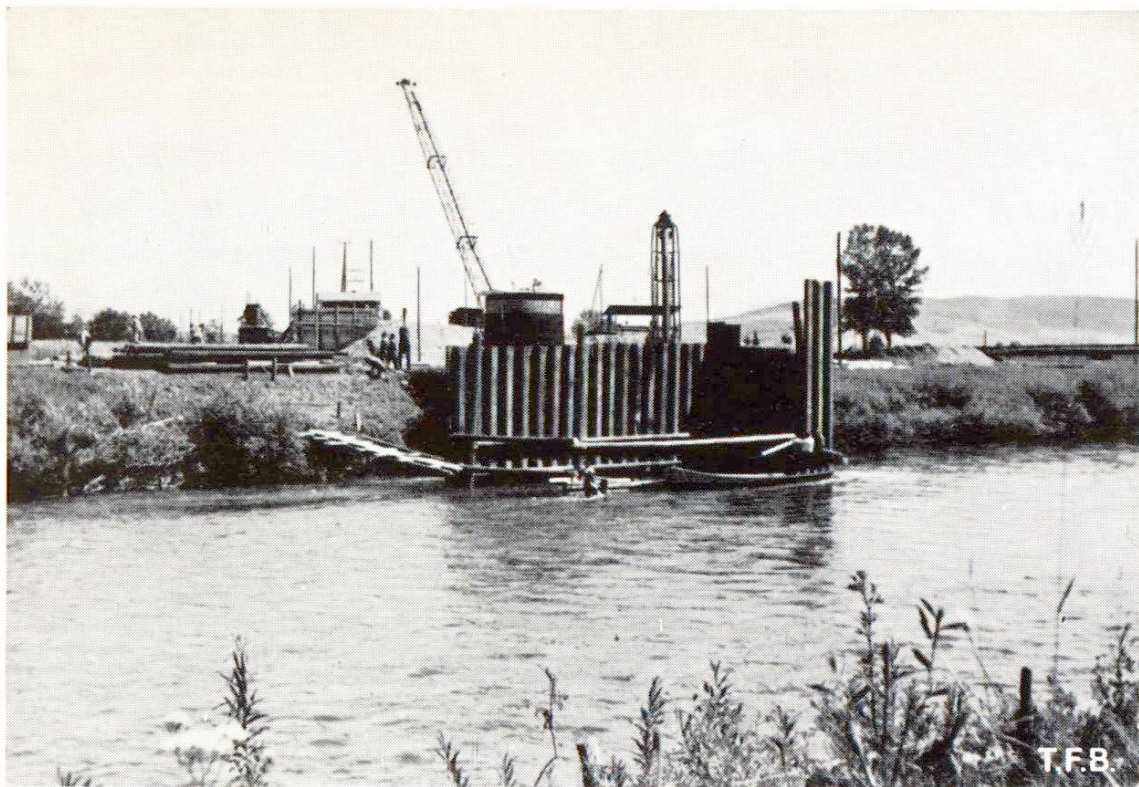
Enceinte de palplanches pour l'établissement de la fondation d'une pile en rivière
